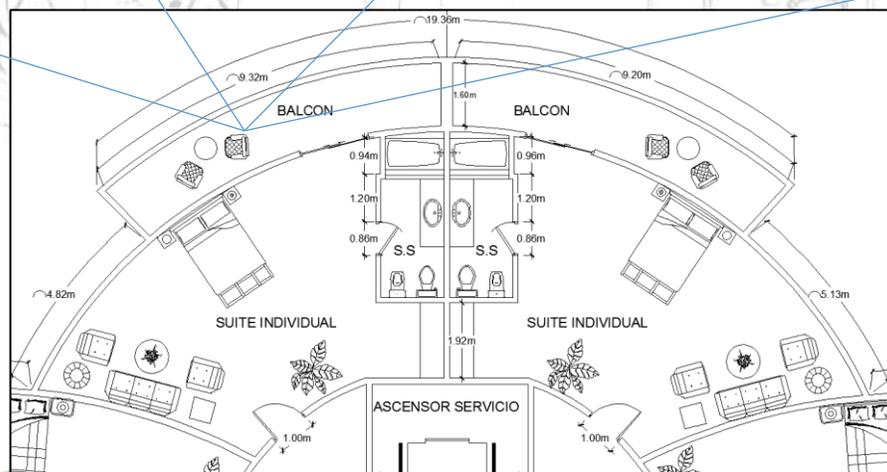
Planta Arquitectónica Suites Individual del Hotel
